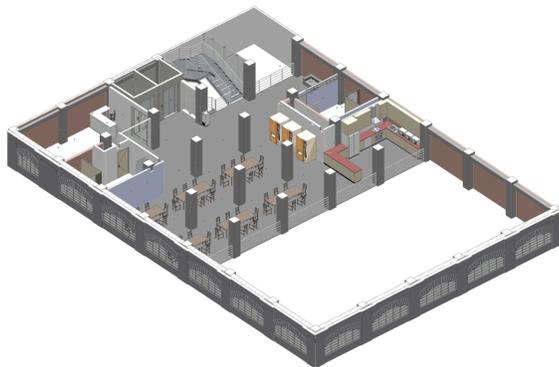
Planta arquitectónica e isometrico de planta baja, mayo 2022
